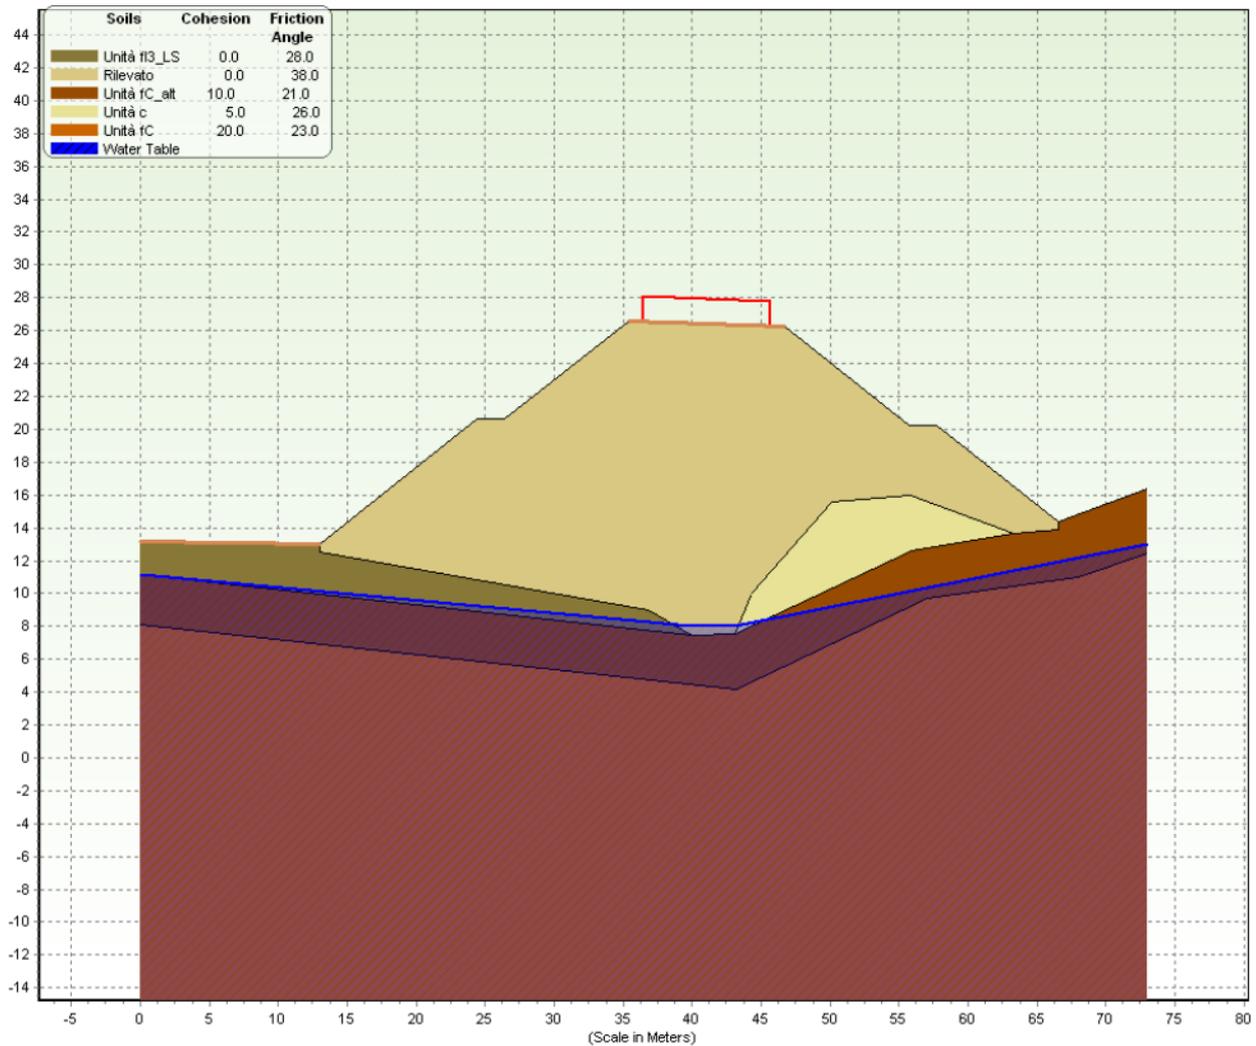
IR1C – Geometria della sezione di calcolo pk 0+286.73
